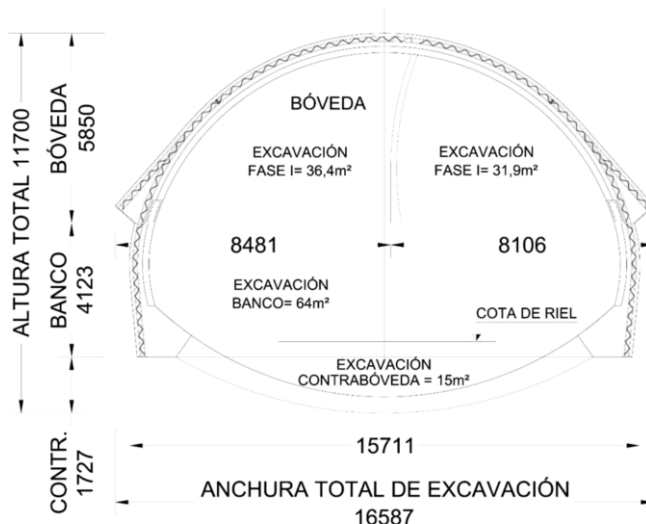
Sección transversal de la galería de conexión-Fase 2 (Salzar B, 2011)
